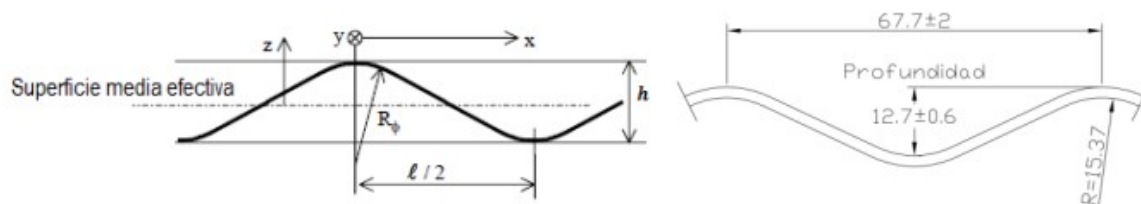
Geometría planchas de acero corrugado estándar Tecnovial S.A
